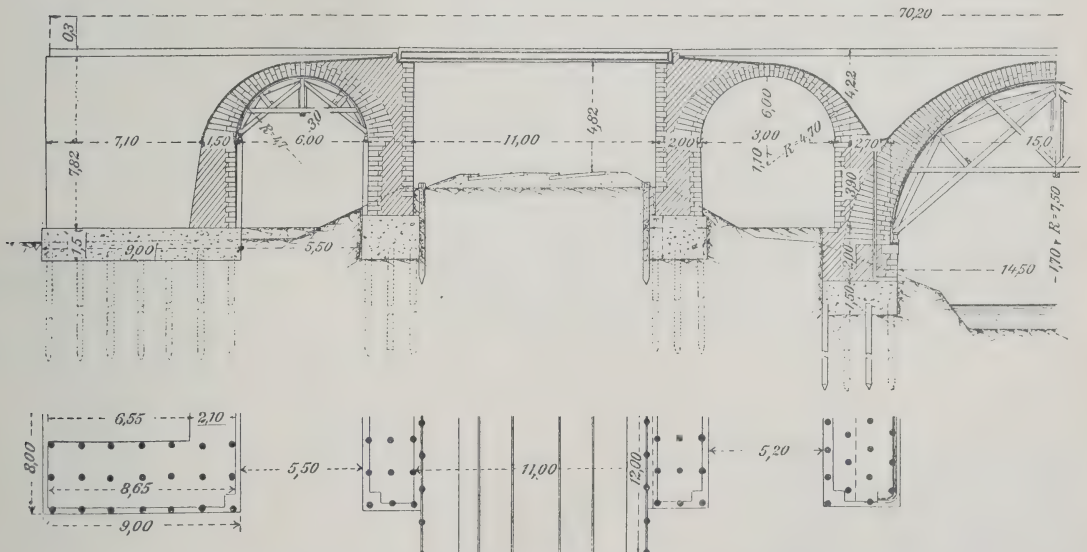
Vergleichender Grundriß bei Pfählung und Compressolpylonen.
